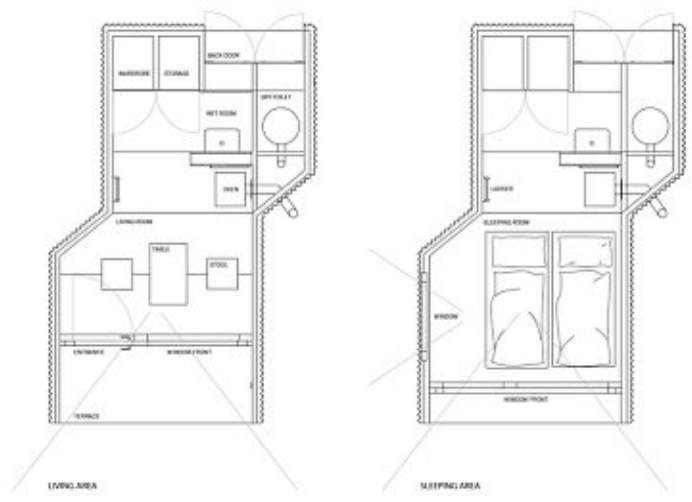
71 Grundriss Erdgeschoss und Obergeschoss
